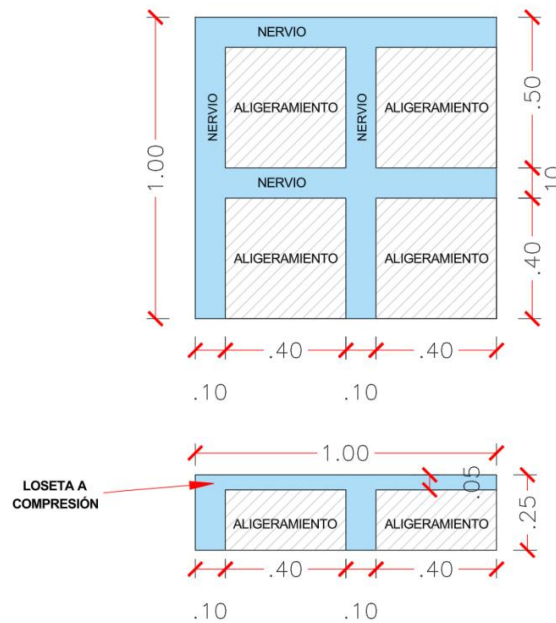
Esquema de la losa aligerada. Elaboración Propia (2025).
